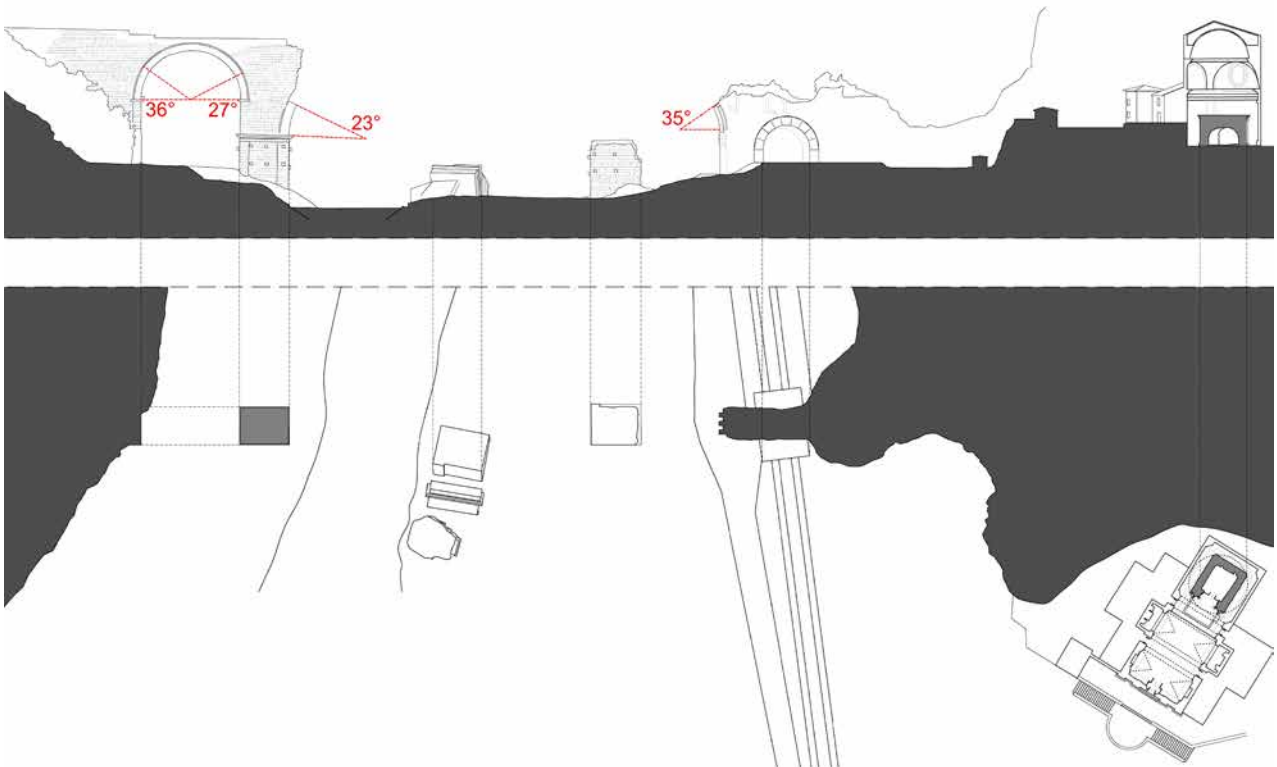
Rilievo del ponte. Prospetto e sezione (Rossi L. e Maiezza P.)
